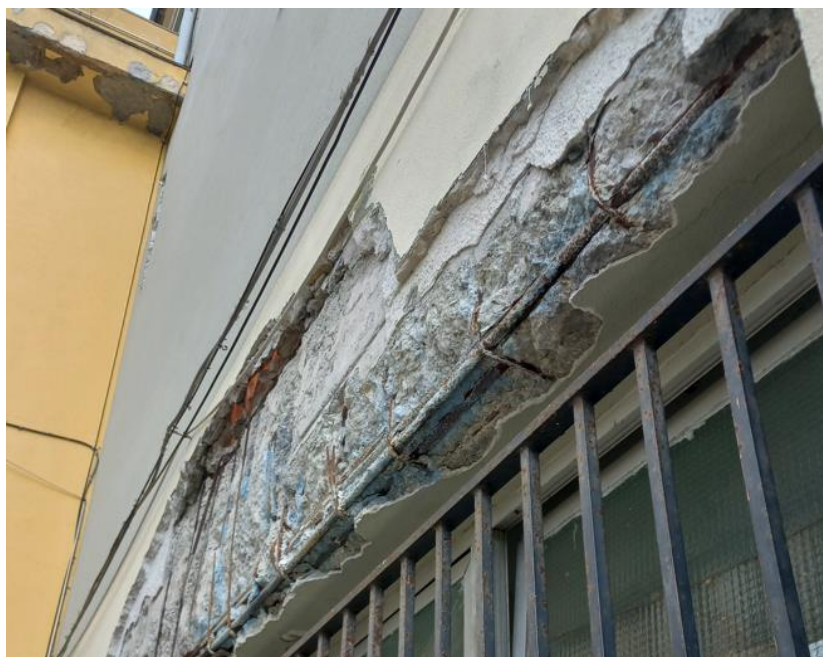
Vista prospetto Nord della struttura della passerella di collegamento con biblioteca
